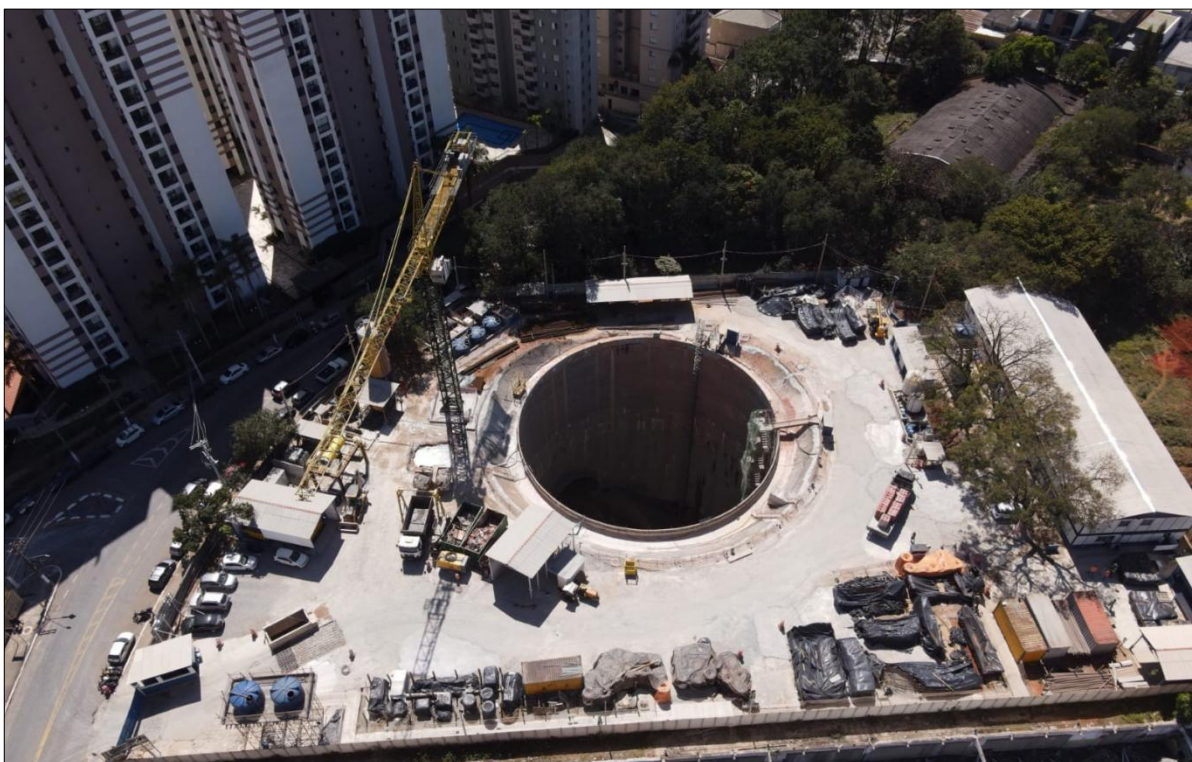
Vista aérea do canteiro de obras da futura estação Santa Isabel imerso em tecido urbano na Av. Guilherme Giorgi, Zona Leste de São Paulo.
